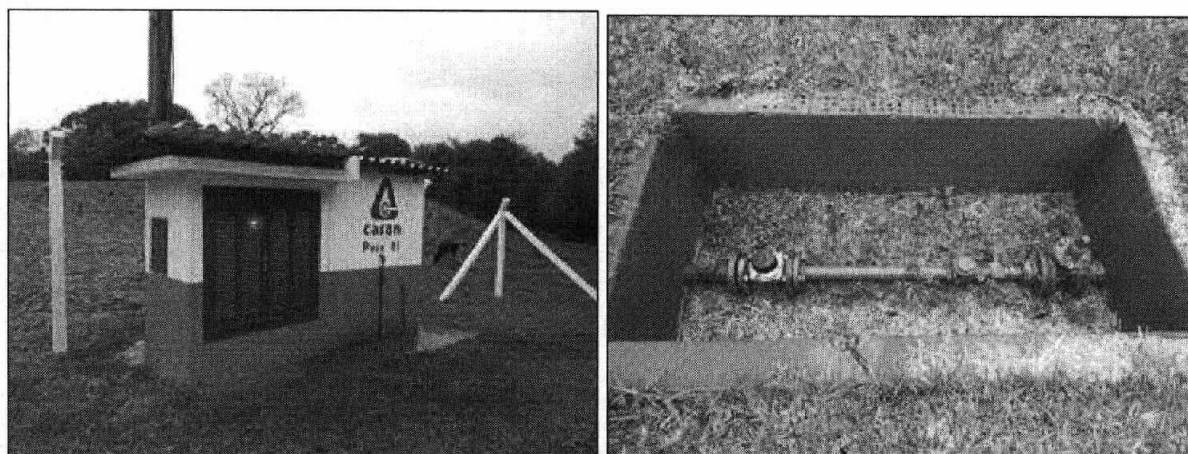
Outras fotos do Poço 01 – Marmeleiro (Acompanhamento)
